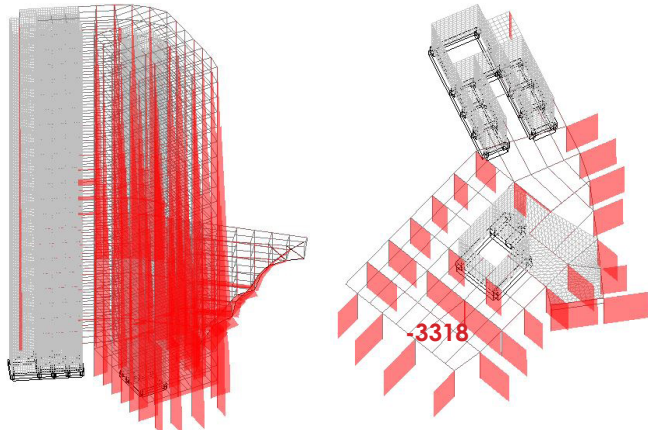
y 116b. Diagramas axiales "Torre". Completo y planta baja
